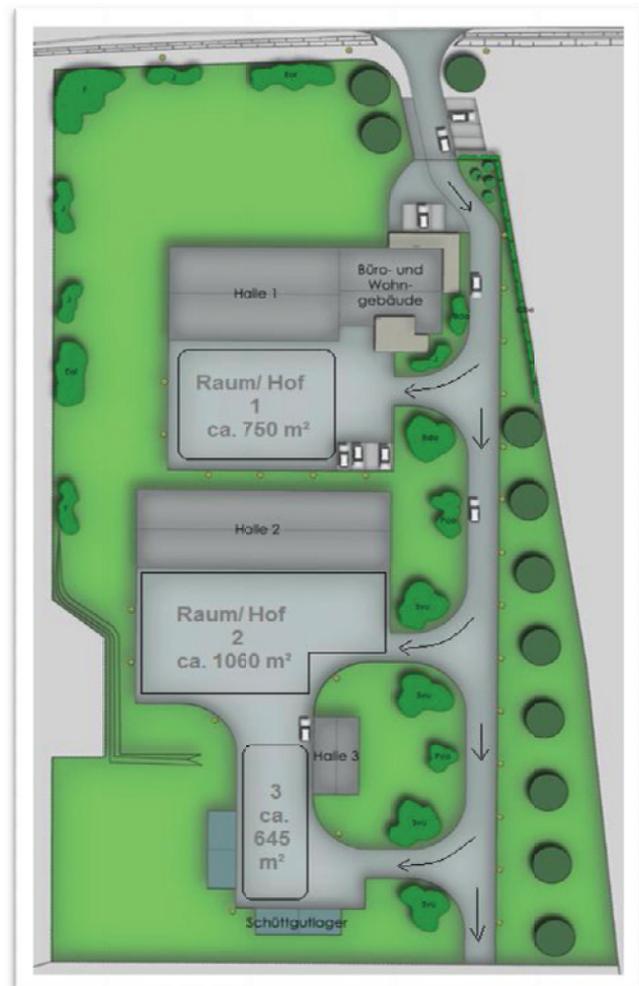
geplante Räume/Höfe und Straßenführung Entwurf 1
